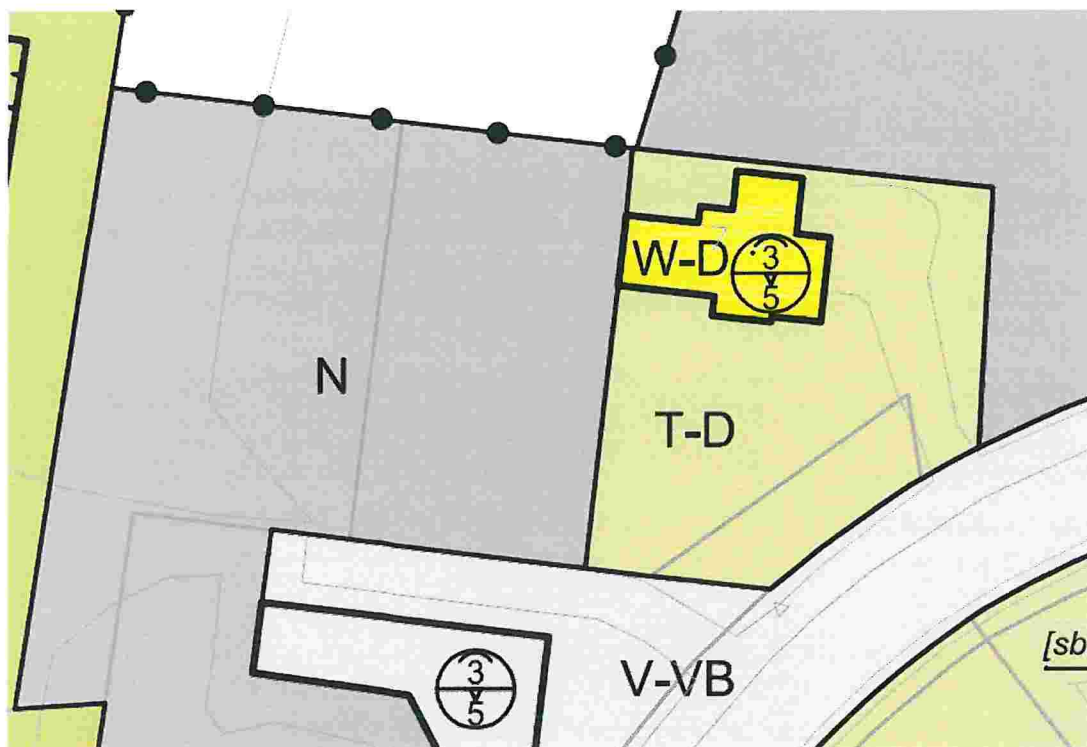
fragment plankaart vigerend bestemmingsplan met betrekking tot C.F. Zeiler Boulevard 7
